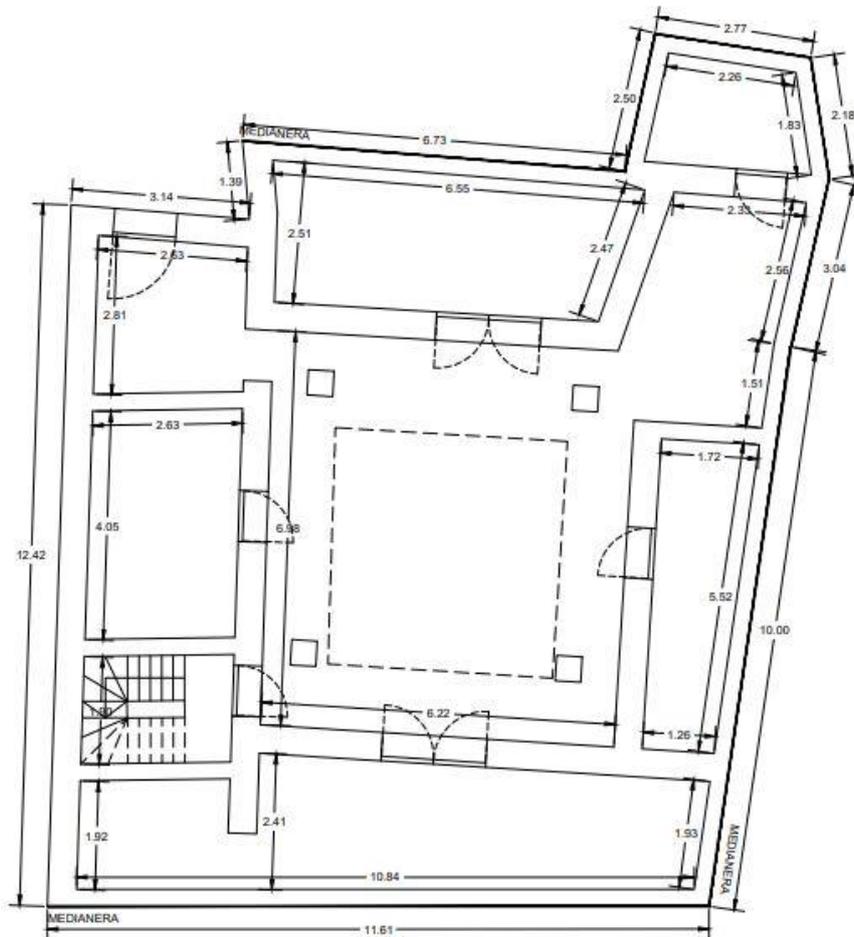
Plano planta baja del edificio (Elaboración propia)
